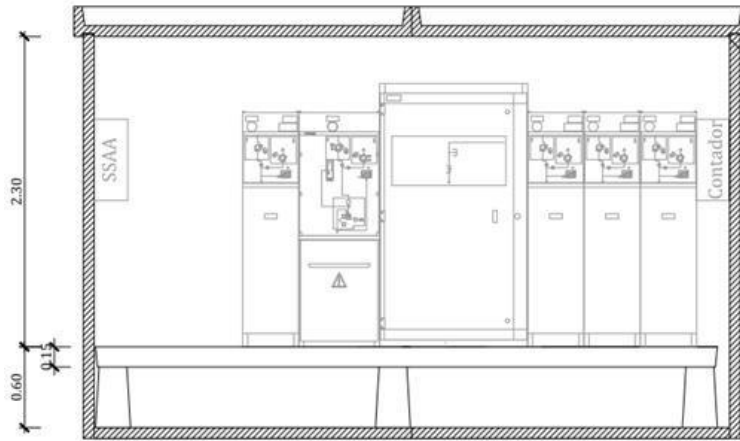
Centro de seccionamiento (sección longitudinal).
